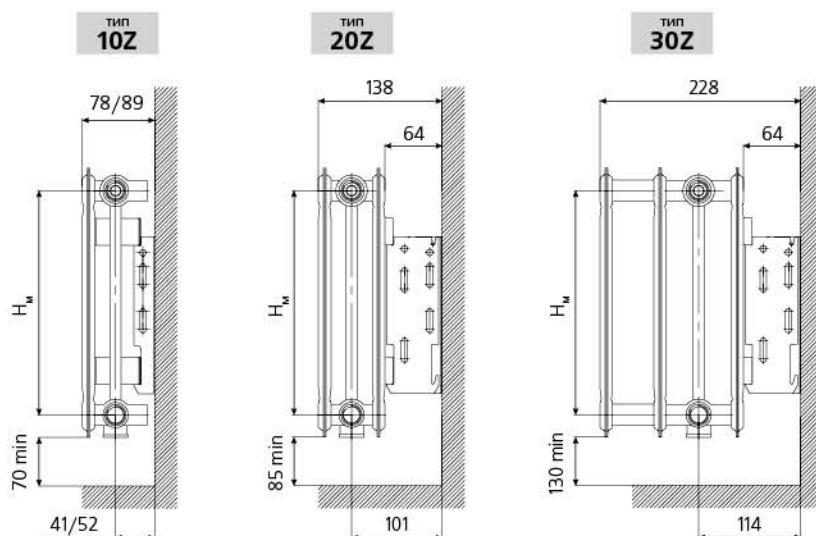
Радиатор «PRADO Universal Z» в разрезе, с двумя нижними и четырьмя боковыми присоединительными отверстиями
